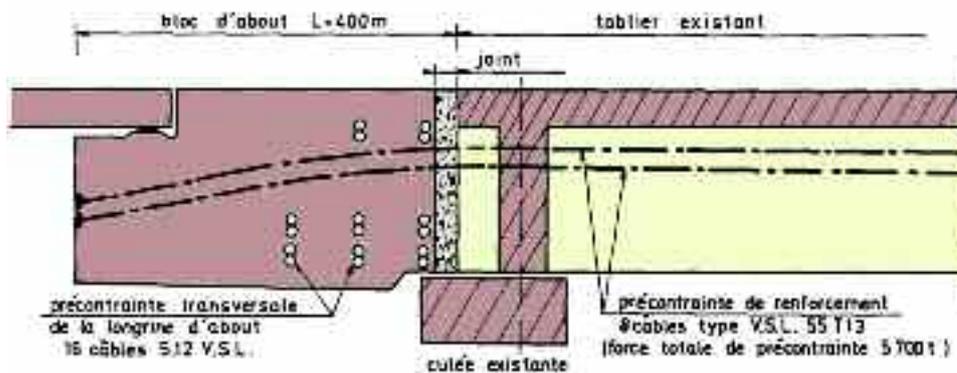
massif d'ancrage rapporté au pont de Roquemaure avec joint coulé en place
